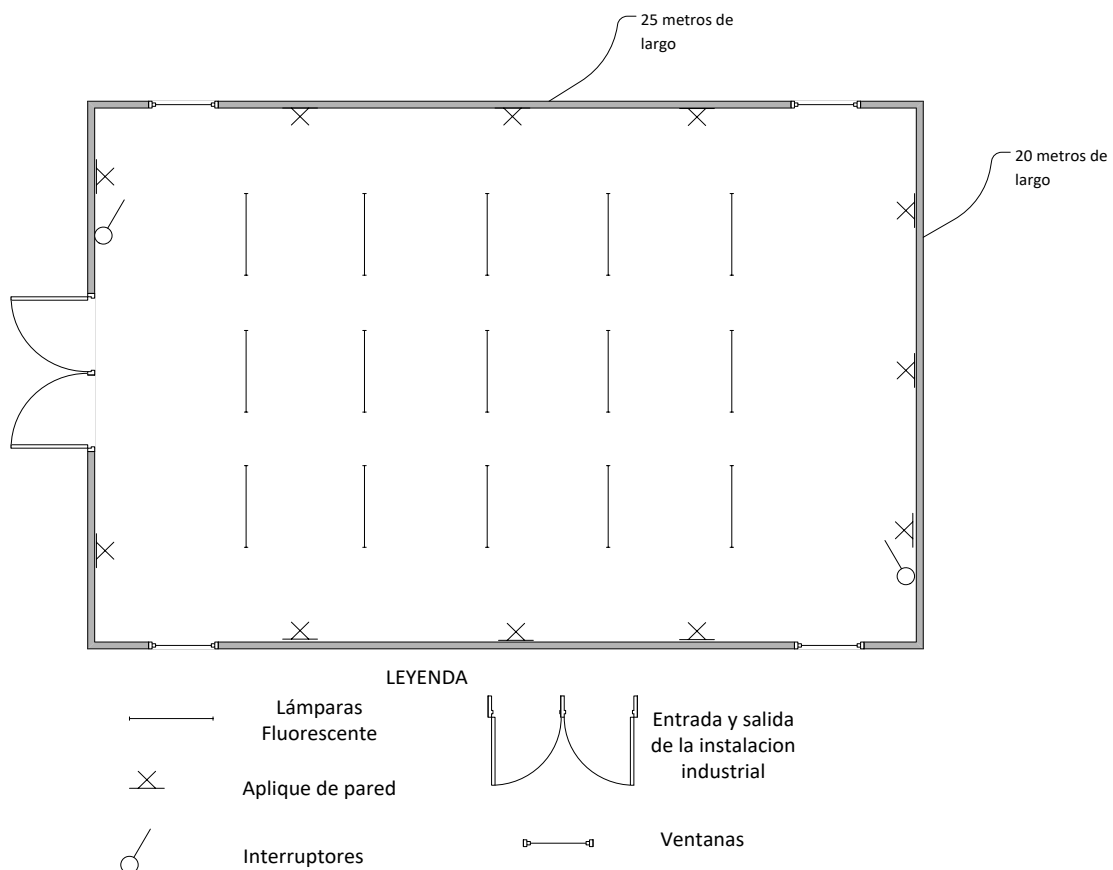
Plano de planta propuesto con distribución de luminarias y ventanas
